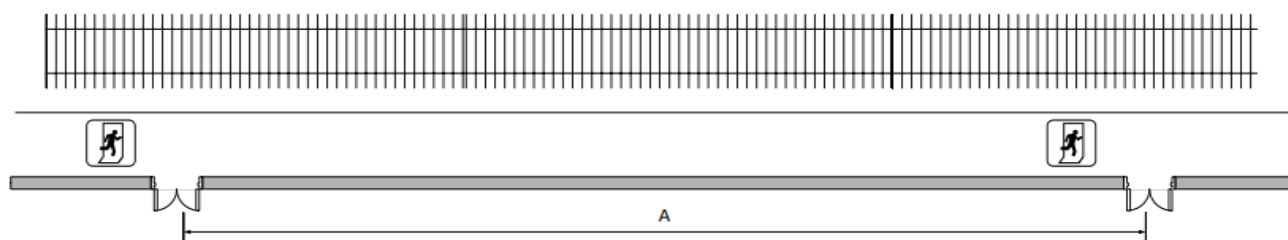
Distanța dintre două treceri transversale de acces către o zonă de siguranță
